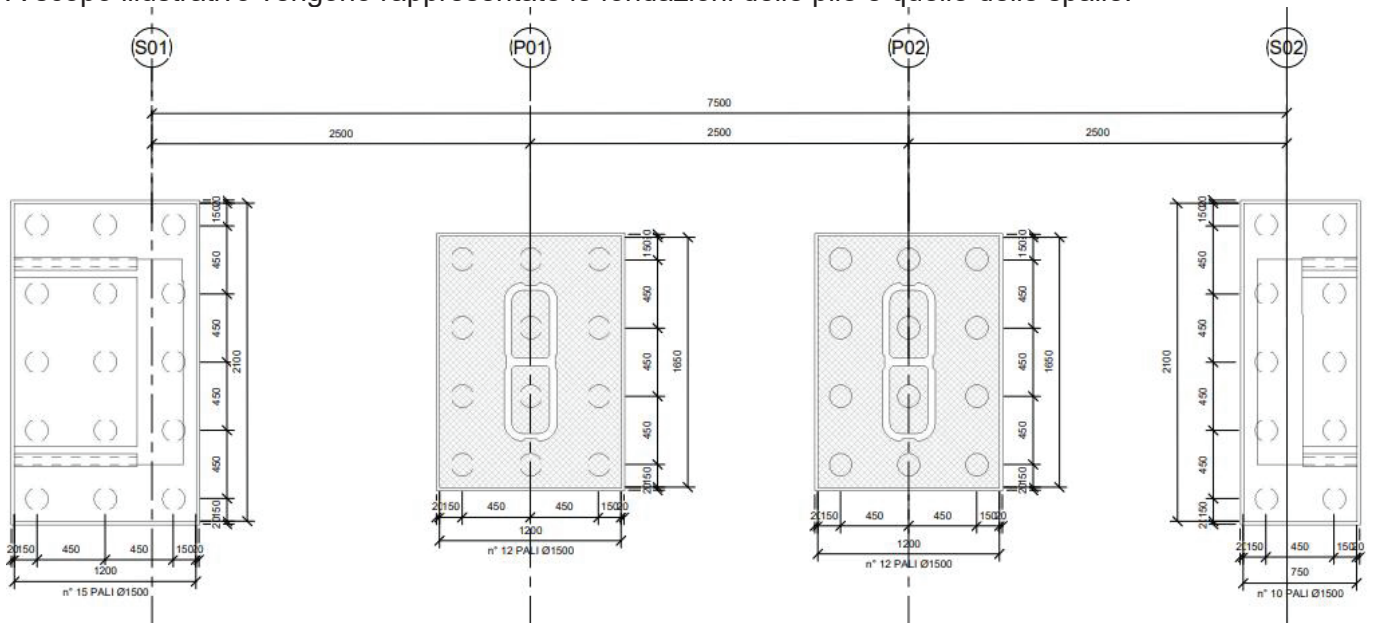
Pianta delle fondazioni delle pile e delle spalle
